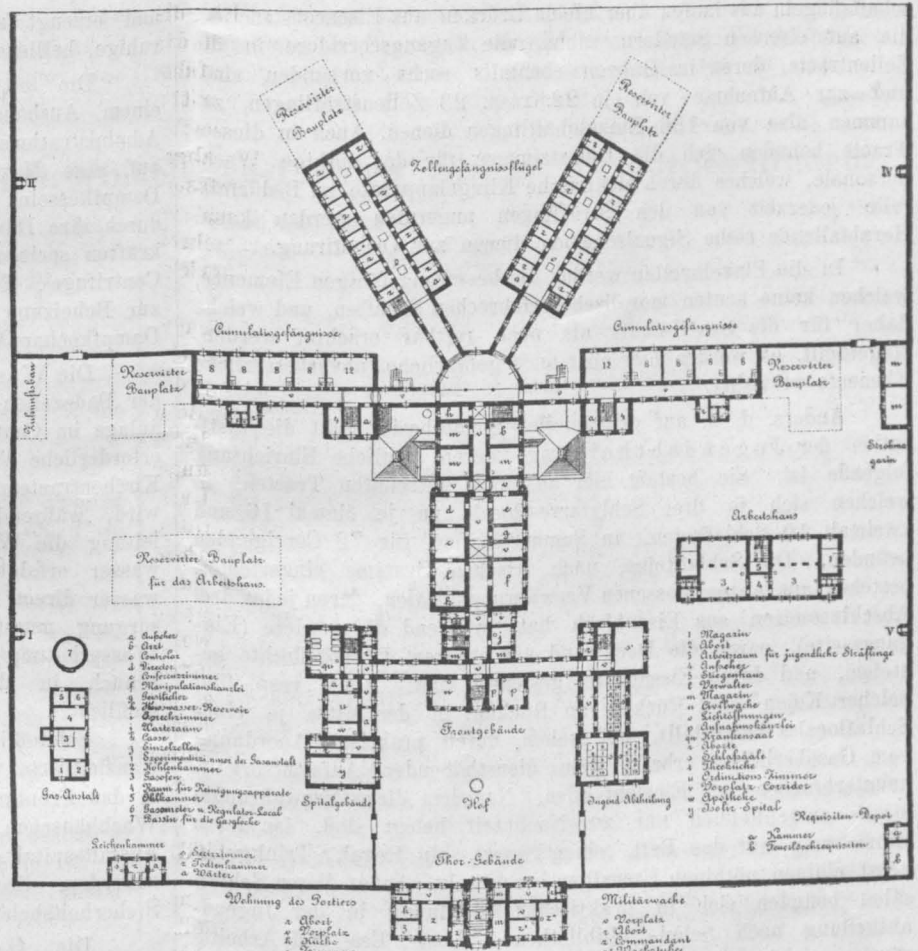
Ebenerd-Grundriss. 1:1470.
